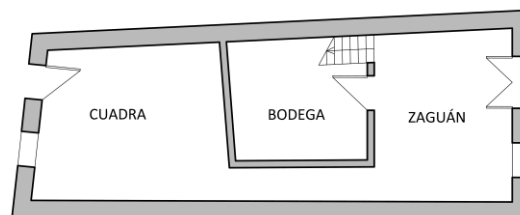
Ejemplo de distribución interior de planta baja en vivienda de entramado de madera (elaboración propia).
